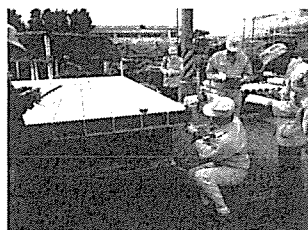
仮組検査状況① 写真-2 仮組検査状況②
